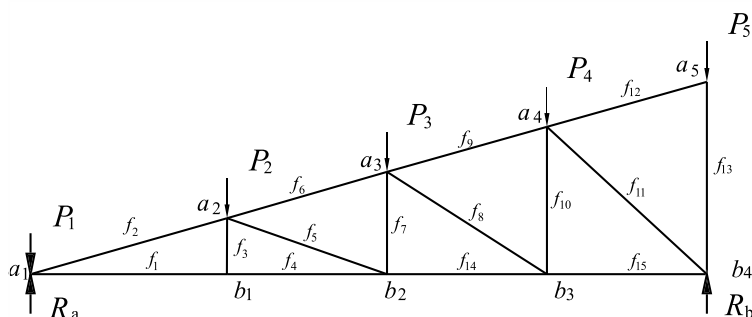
Поэлементная расчетная схема фермы Ф-1
